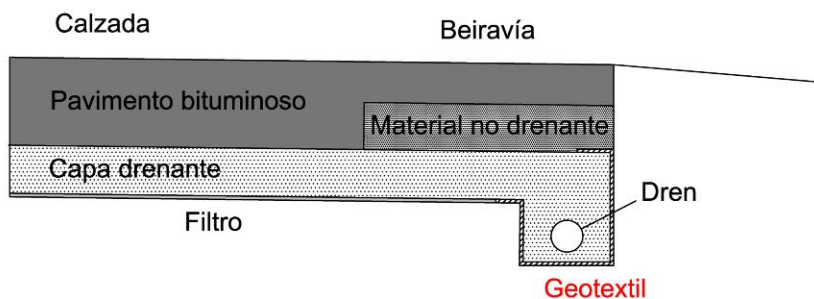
Capa drenante baixo pavimento bituminoso con gabia drenante provista de dren
